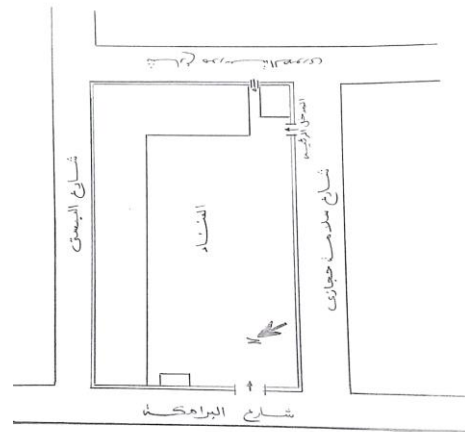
مسقط أفقي لمدرسة الرحمة.
